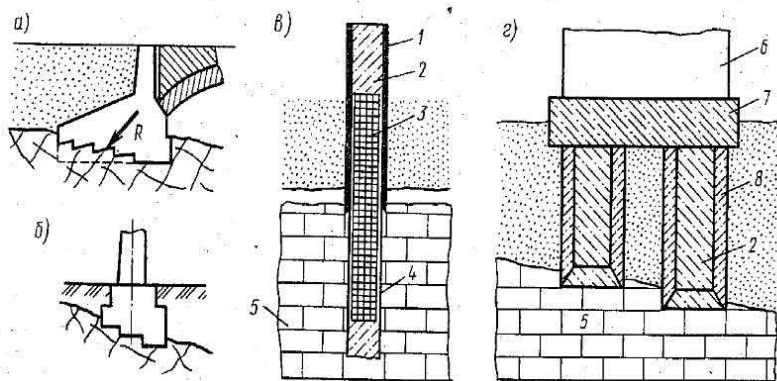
Характерные схемы фундаментов на скальных грунтах:
